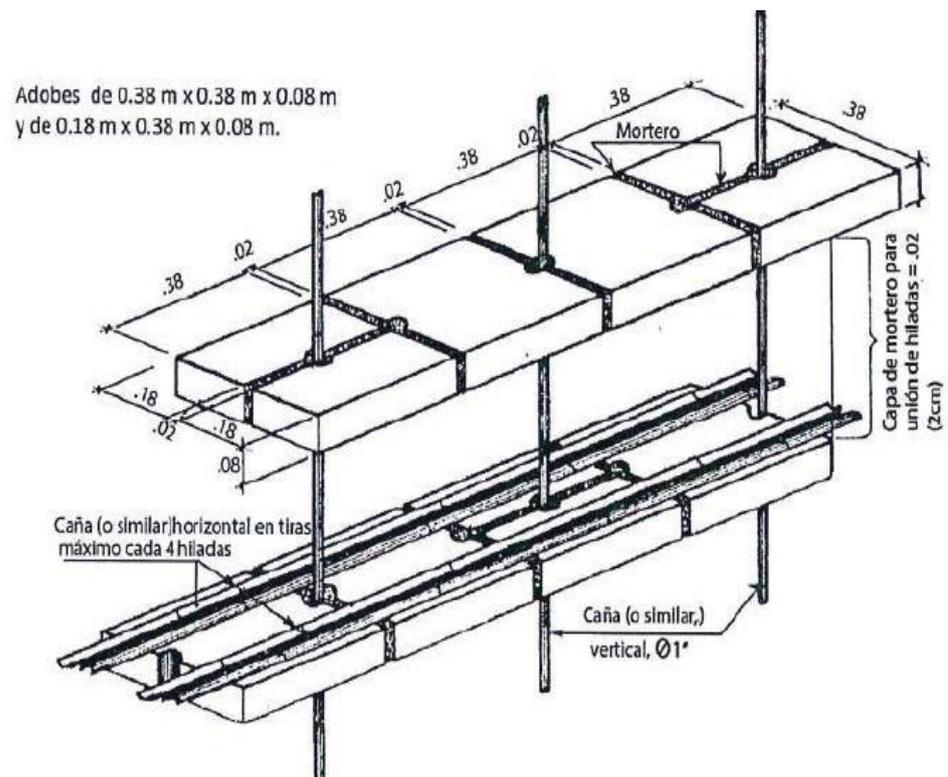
Esquema de refuerzos horizontal y vertical con caña o similar como máximos a cada 4 hiladas.
